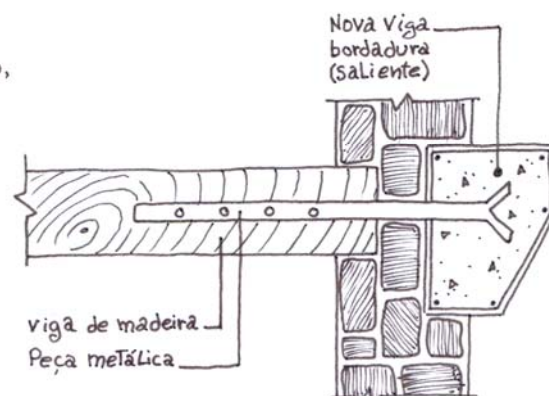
b | Com varões de aço incrustados em viga de bordadura saliente de betão armado / cintado
